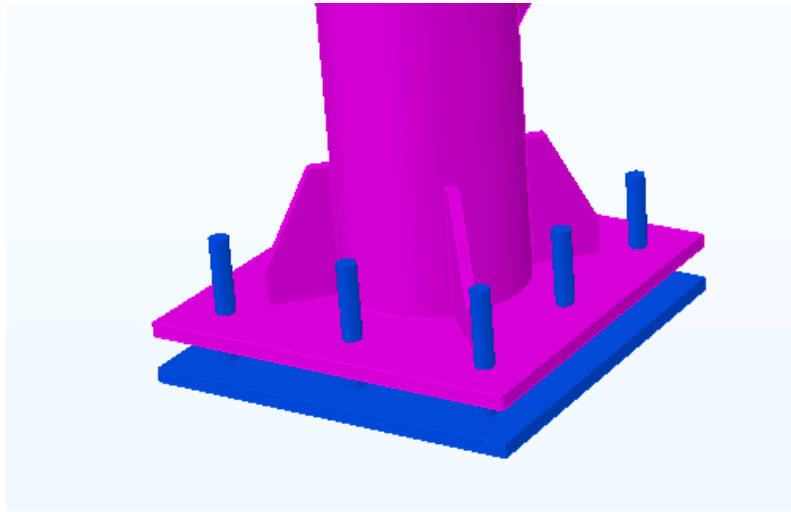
Vista 3D de la placa base de los pilares de la torre de llegada. Fuente: Memoria de cálculo de la Torre Multiaventura
